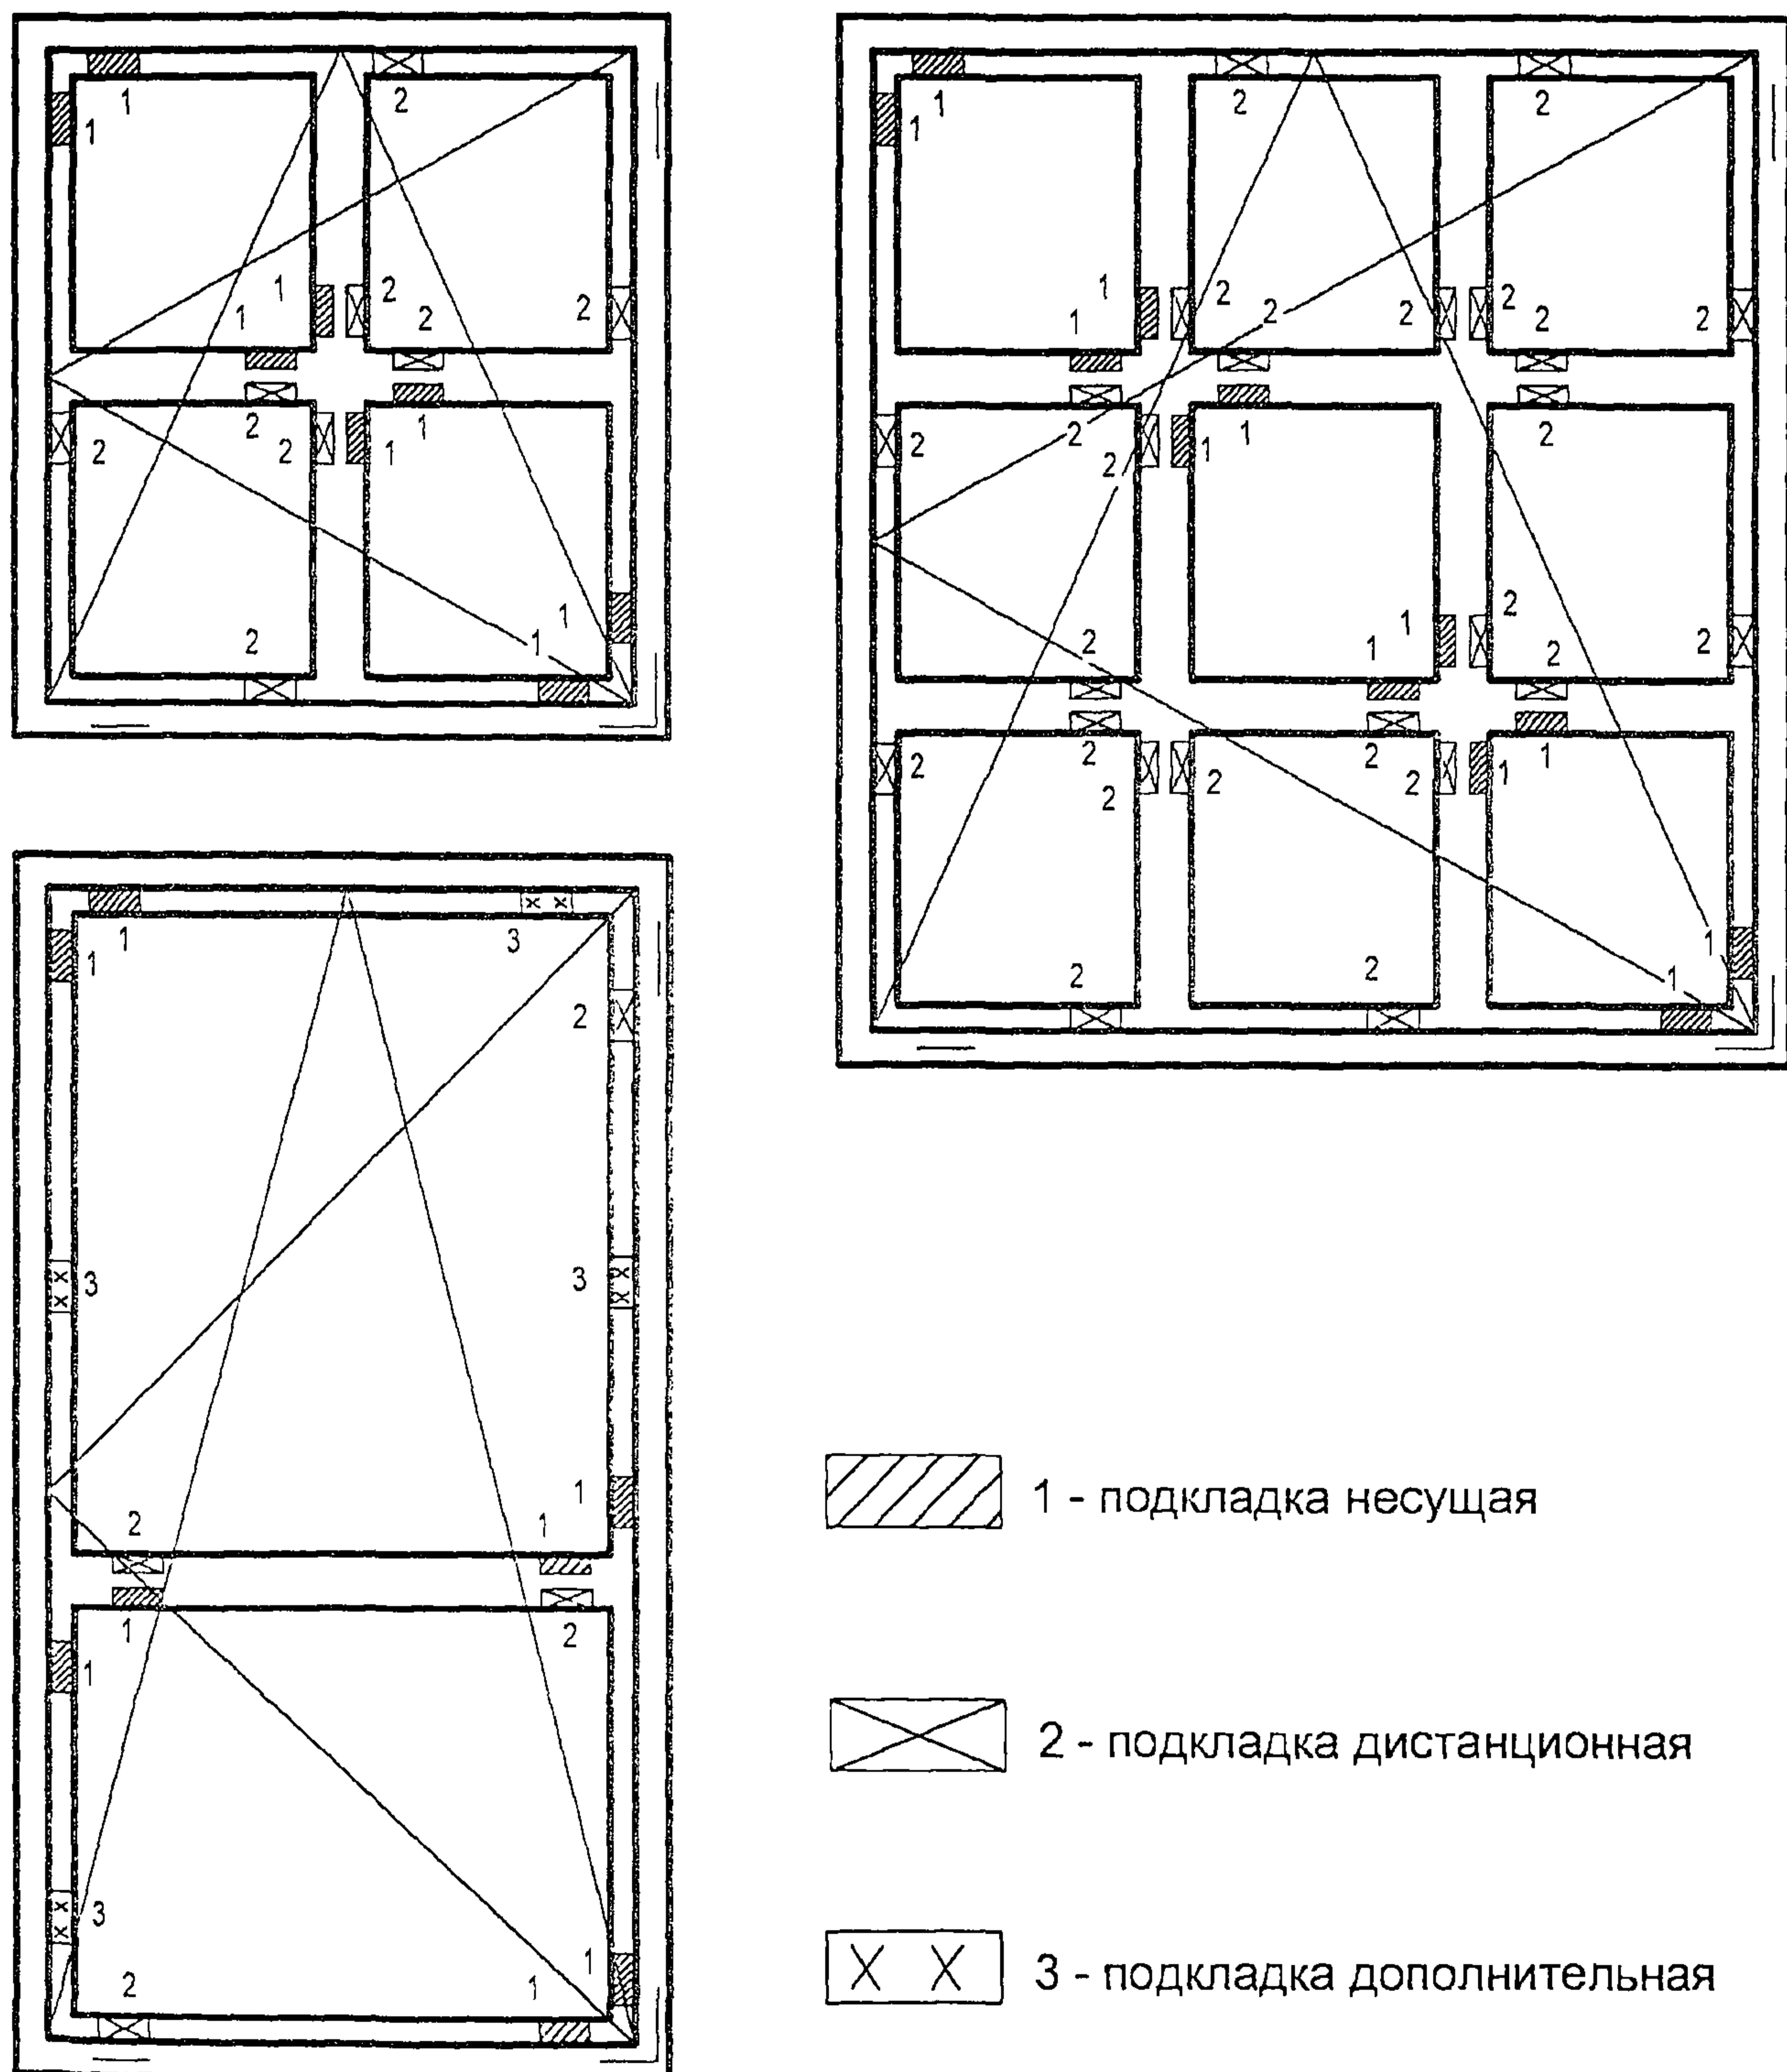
Схемы расположения подкладок в сложных оконных и балконных дверных блоках
